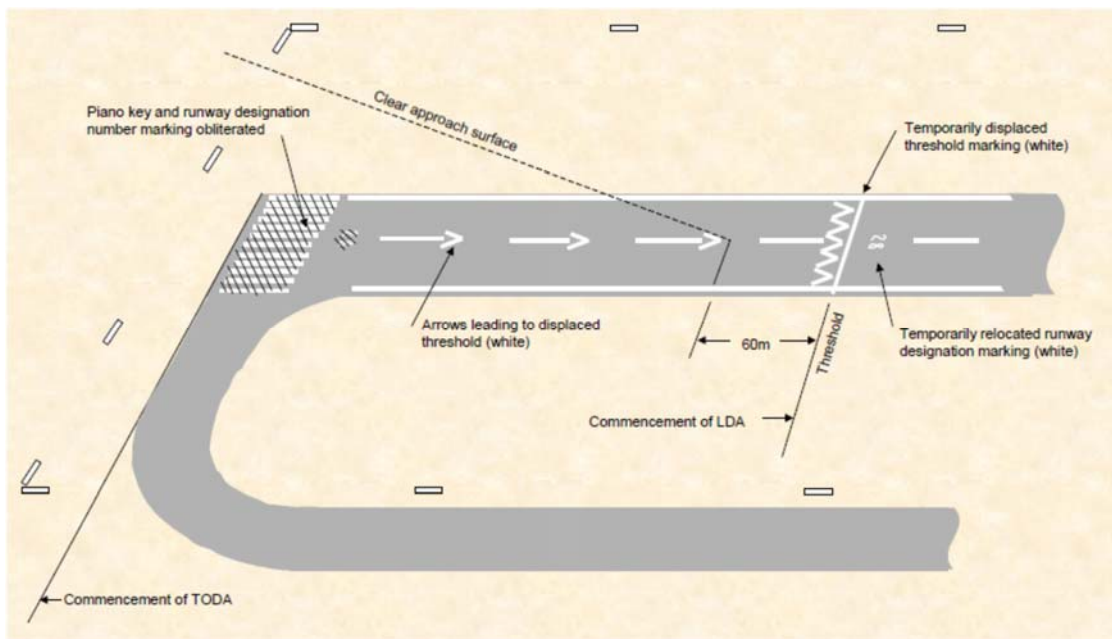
Vijëzimet për një prag të zhvendosur përkohësisht për shkak të infiltrimit të pengesave në sipërfaqen e afrimit për një periudhë më të madhe se 30 ditë
